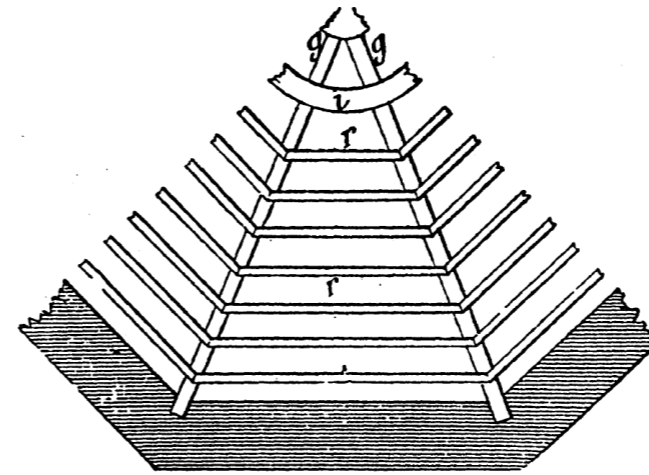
Detalle de posición de vigas y viguetas para una forma poligonal o curva, aplicable a vigas de madera y de hierro
